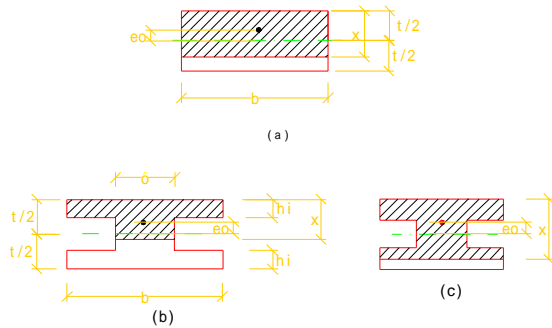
墙板出平面偏心受压的受压区面积
